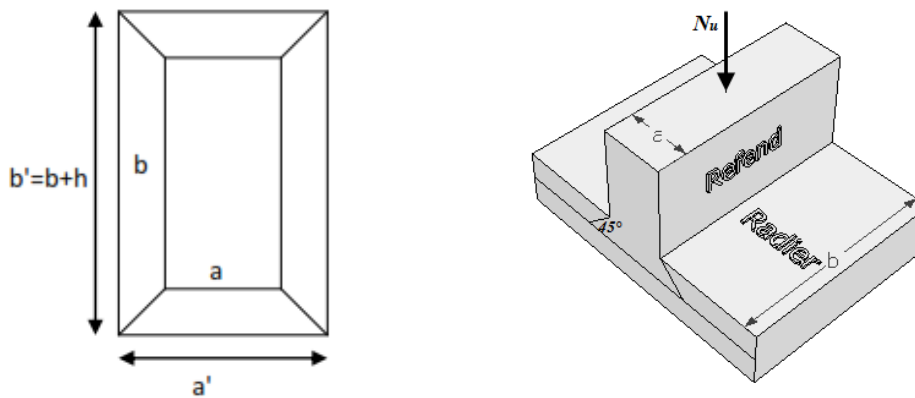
Périmètre utile des voiles et des poteaux.
